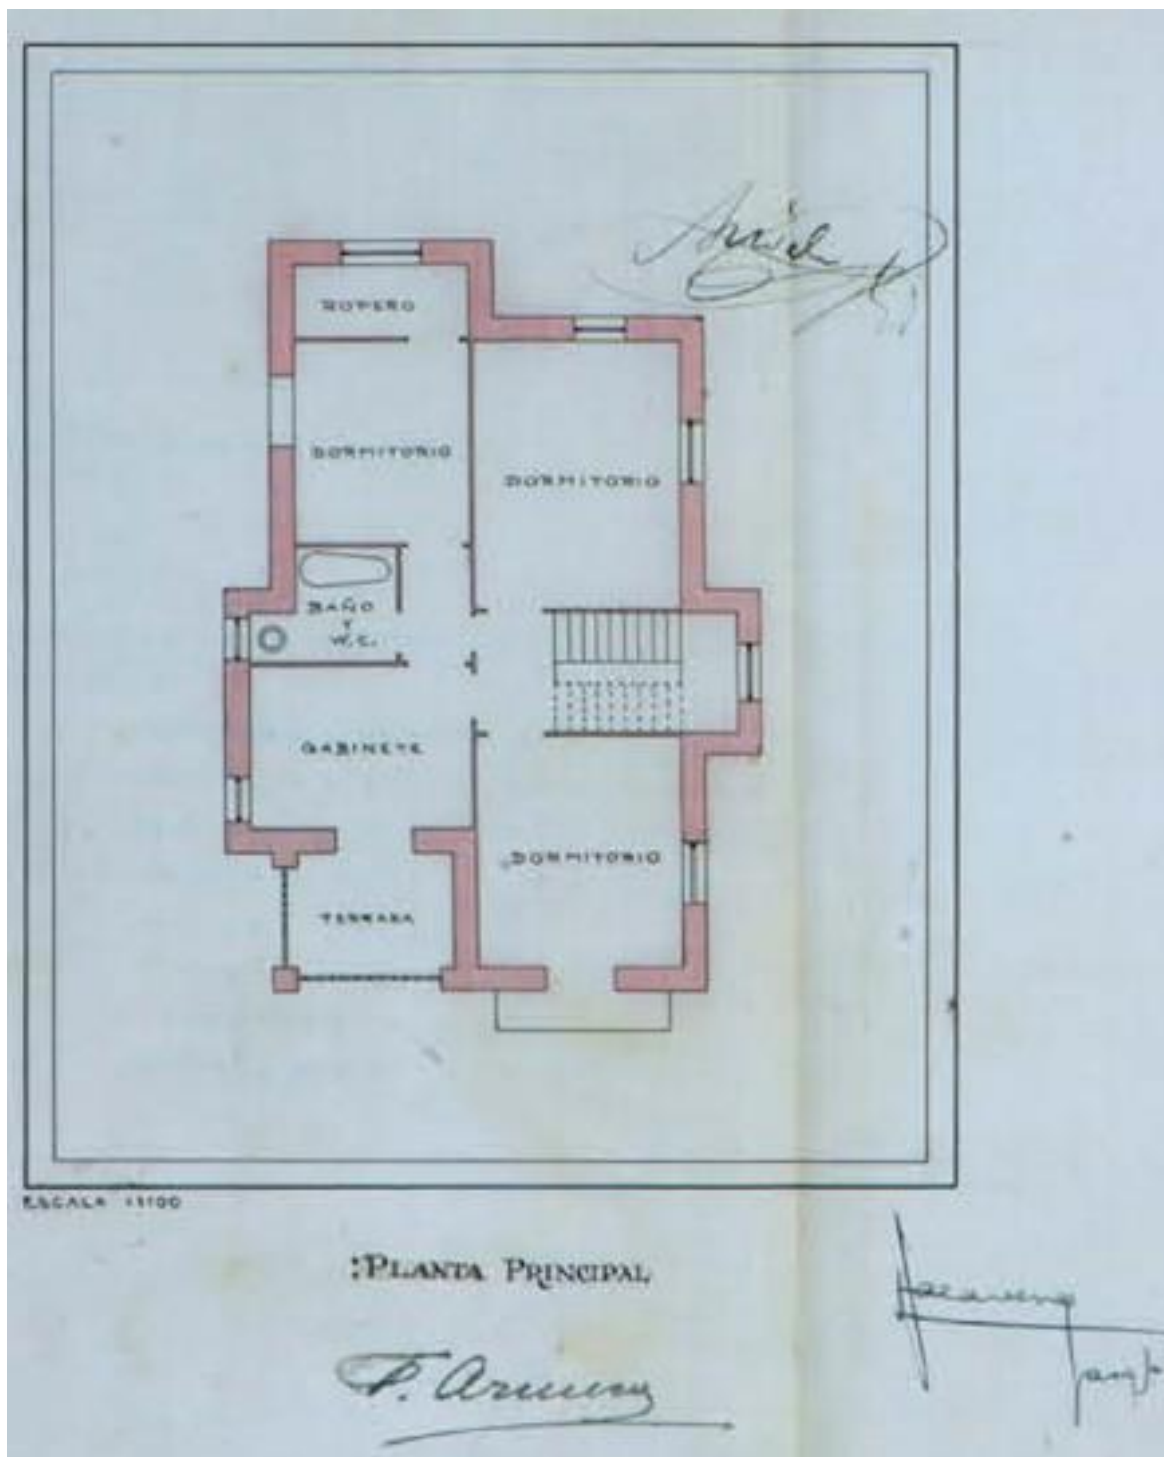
Plano original de planta principal (Fuente: Gerencia de Urbanismo)
